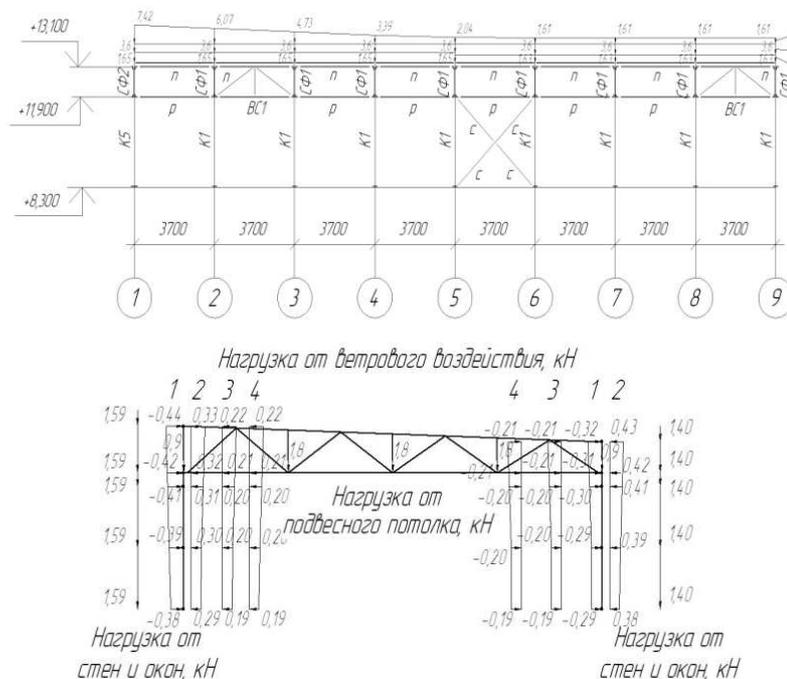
Продольный и поперечный разрез каркаса и действующие нагрузки
